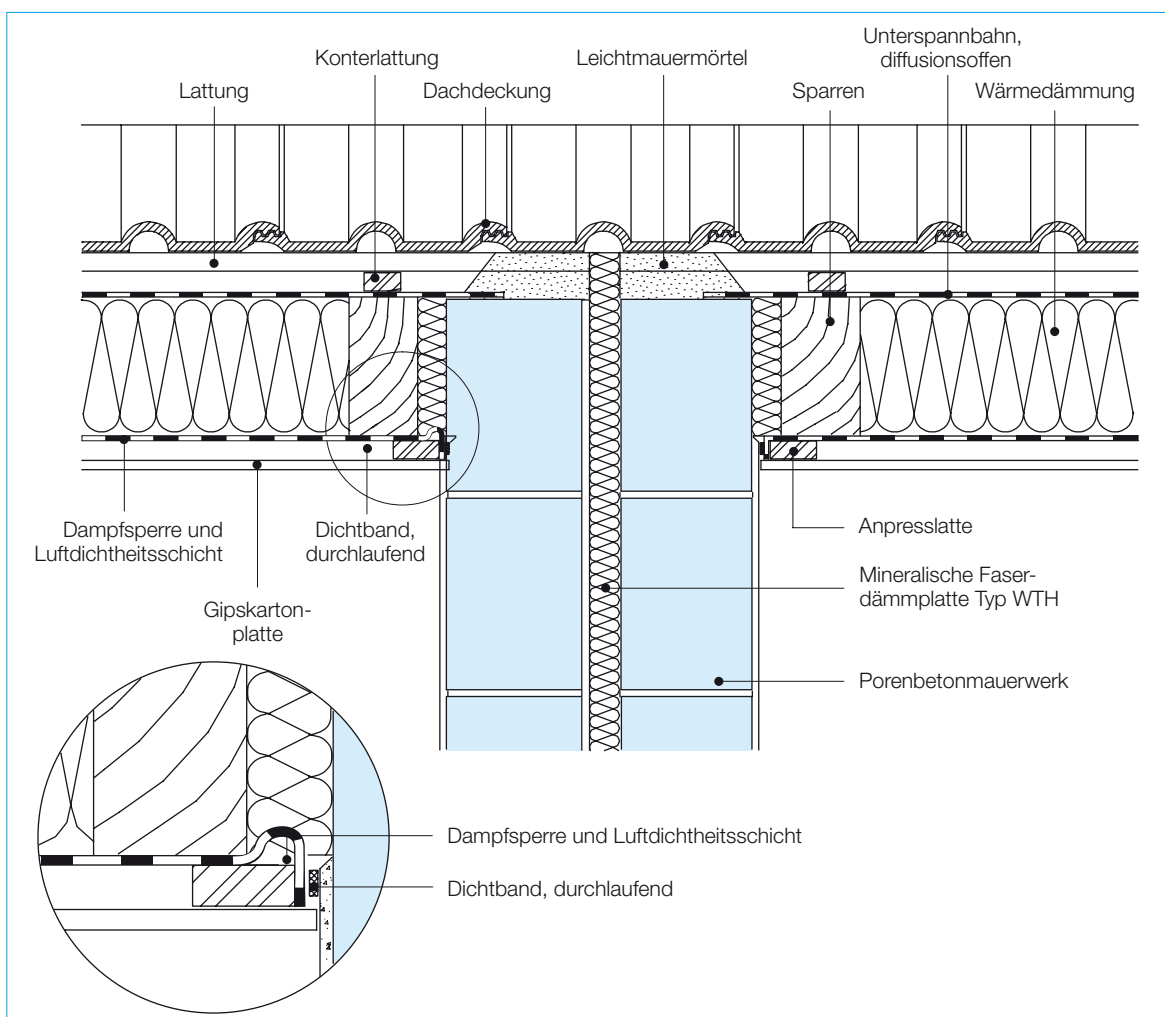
Dachanschluss bei zweischaliger Haustrennwand aus Porenbetonmauerwerk (Holzdach)
